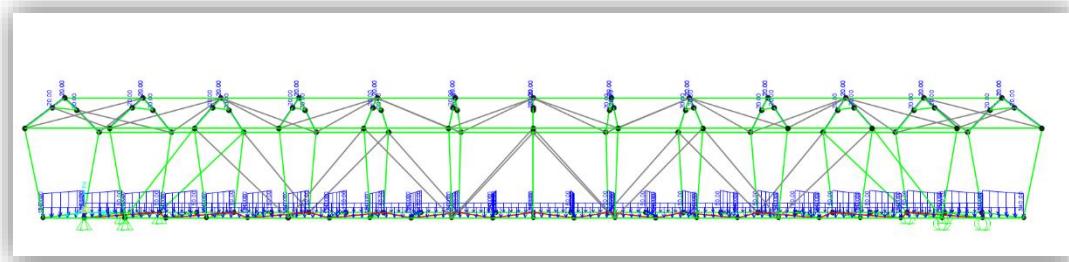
Vista en Sección Longitudinal de la estructura con carga muerta Permanente (DEAD).
